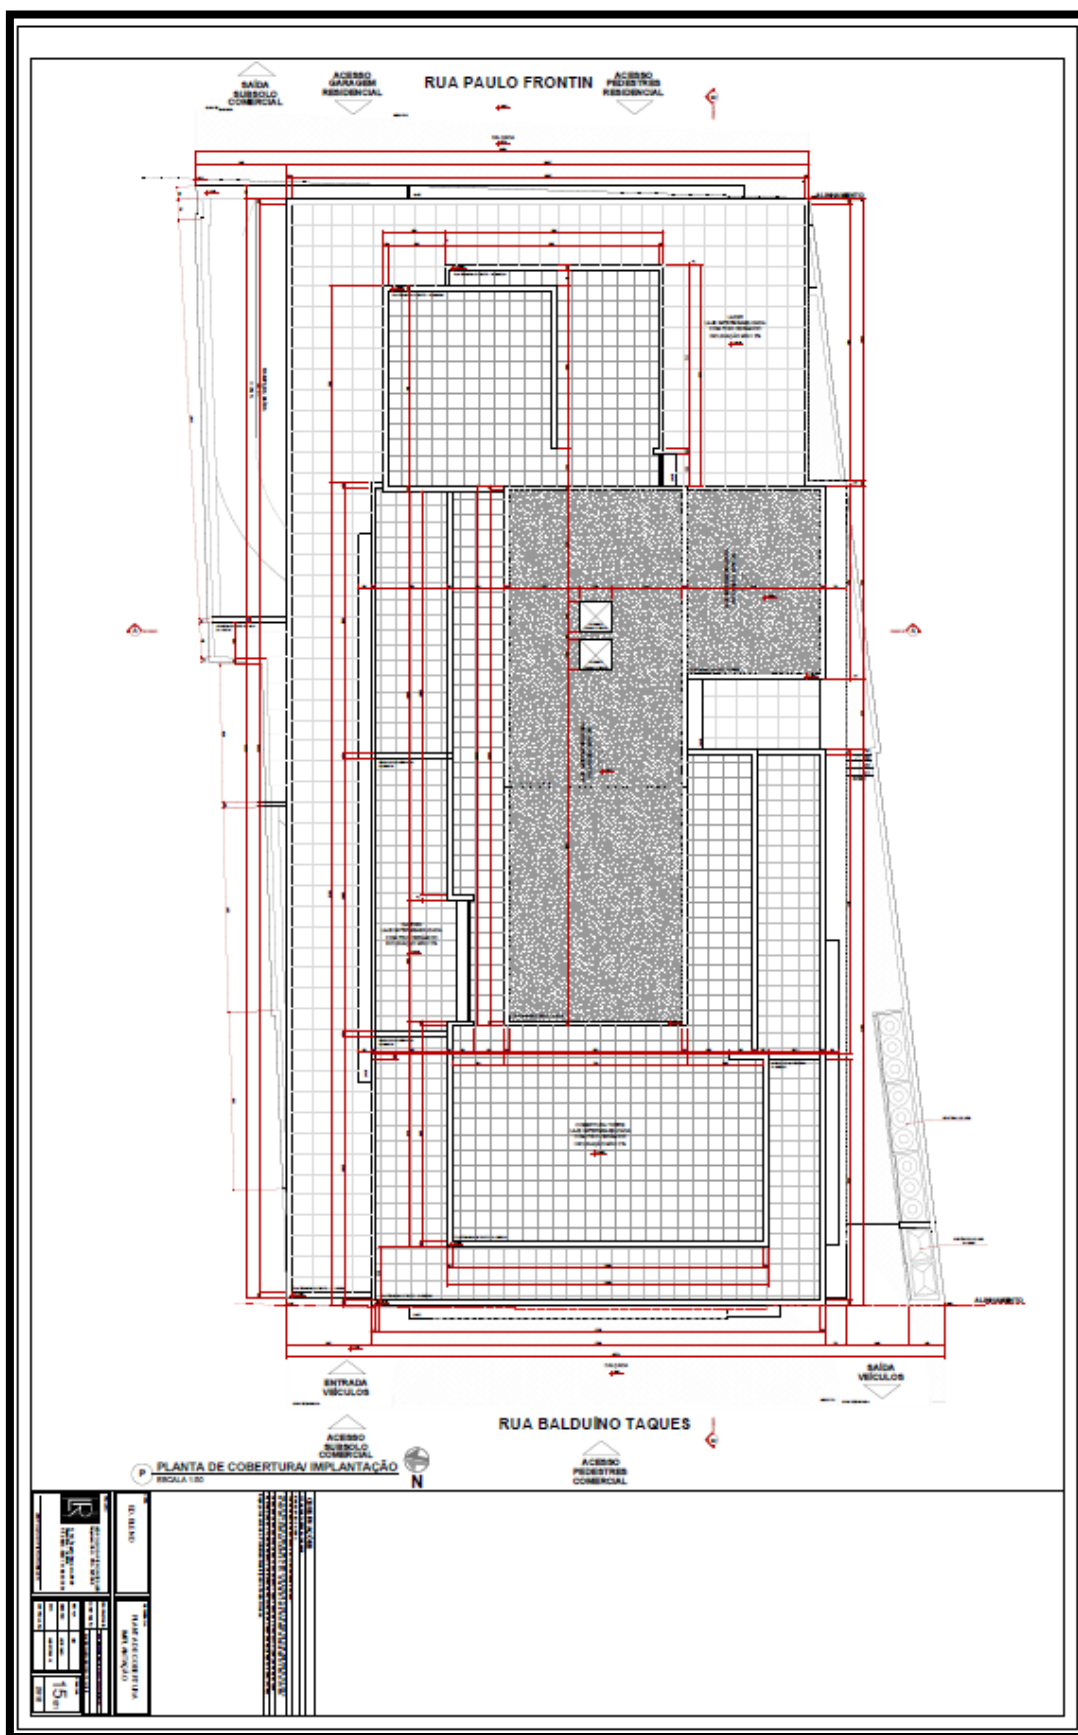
Planta Baixa Projeto Arquitetônico – Pavimento Cobertura
